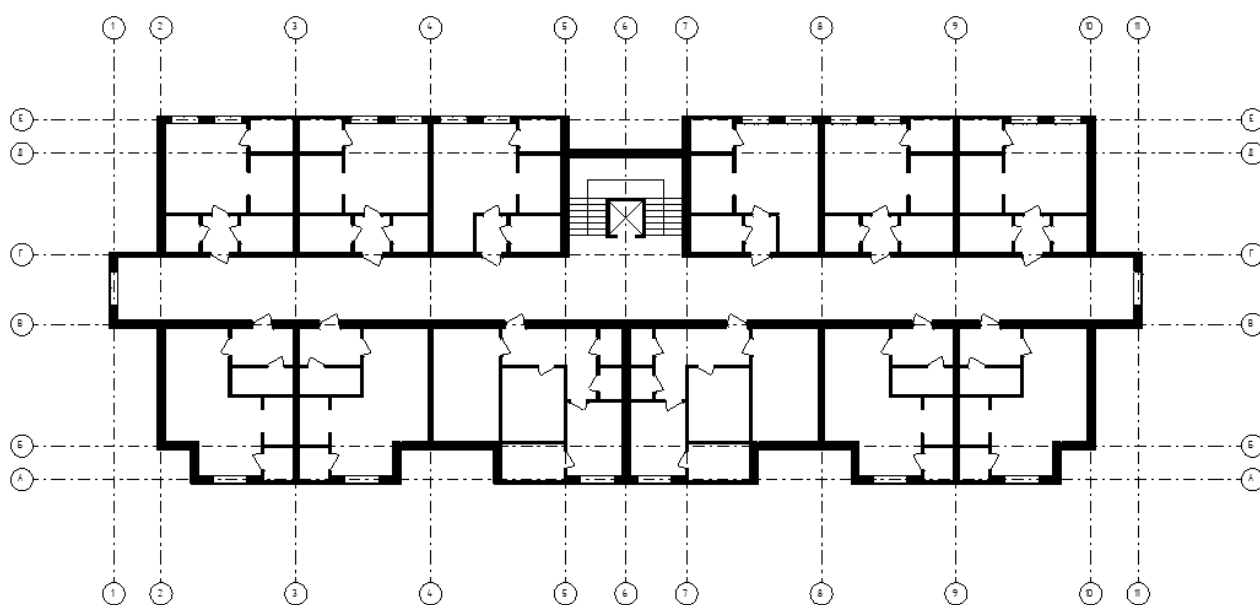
План 1 – го поверху будівлі 3 – го типу
